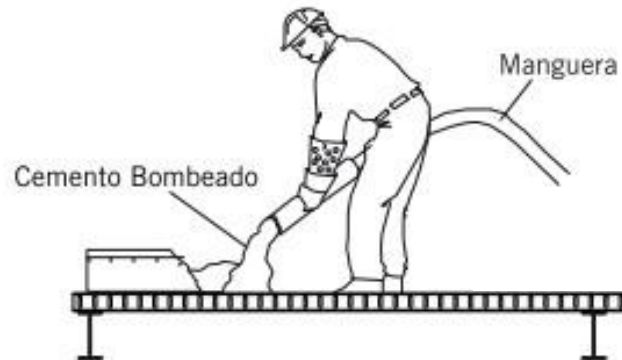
Bombeado de cemento en losacero. Manual de instalación Ternium losacero. sección 4.
